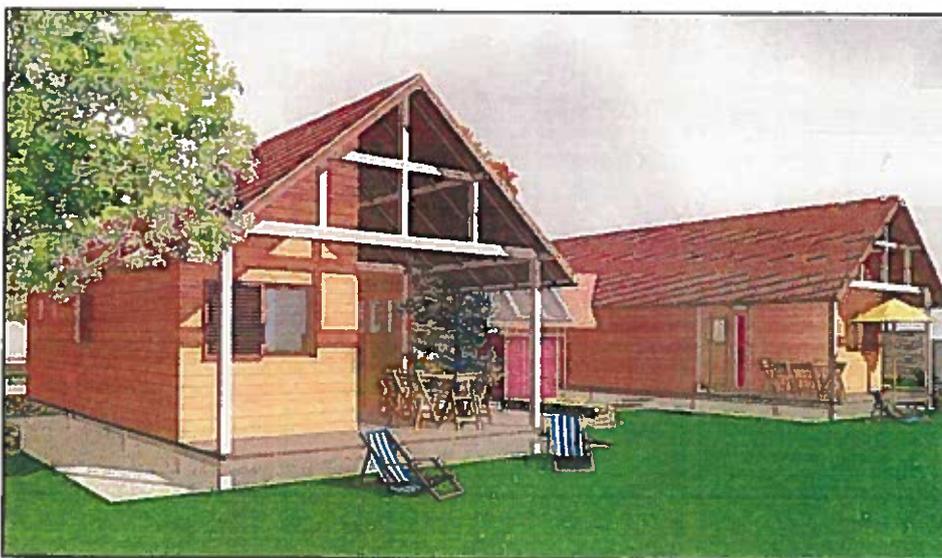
Projet d'hébergement touristique en cours de construction au domaine du Ciran, Ménestreau-en-Villette
